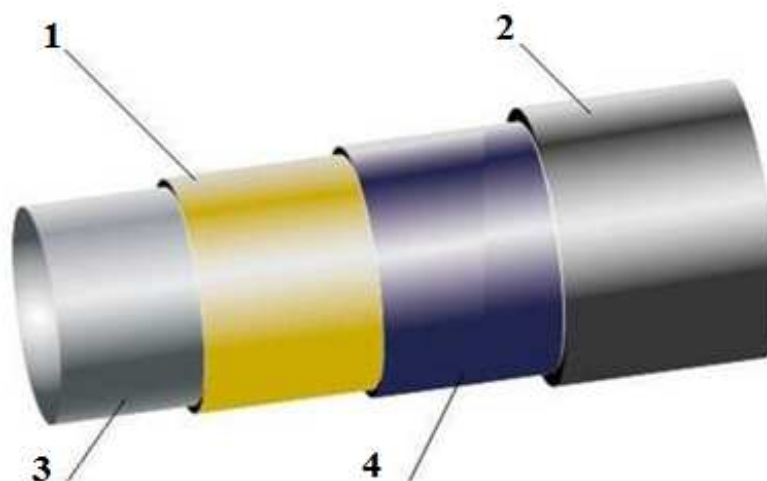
Конструкция защитного покрытия стальной трубы на основе полимерных лент
